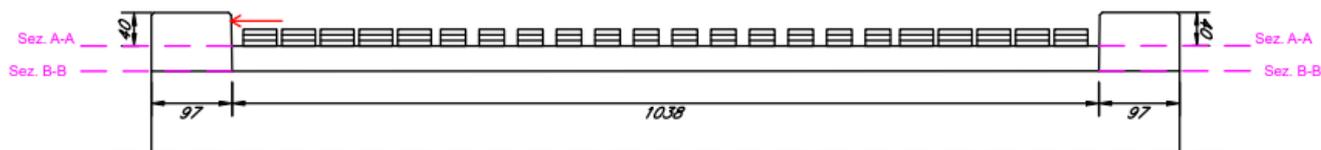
Schema di applicazione delle forze sul ritegno sismico trasversale (Prospetto)
